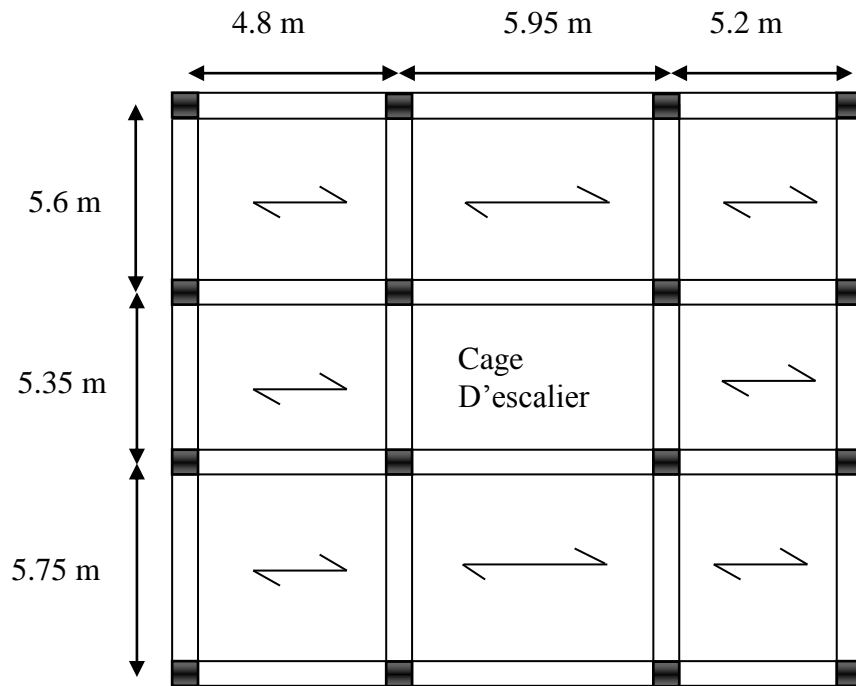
Sens de la disposition des poutrelles du 5em et 6em étage
